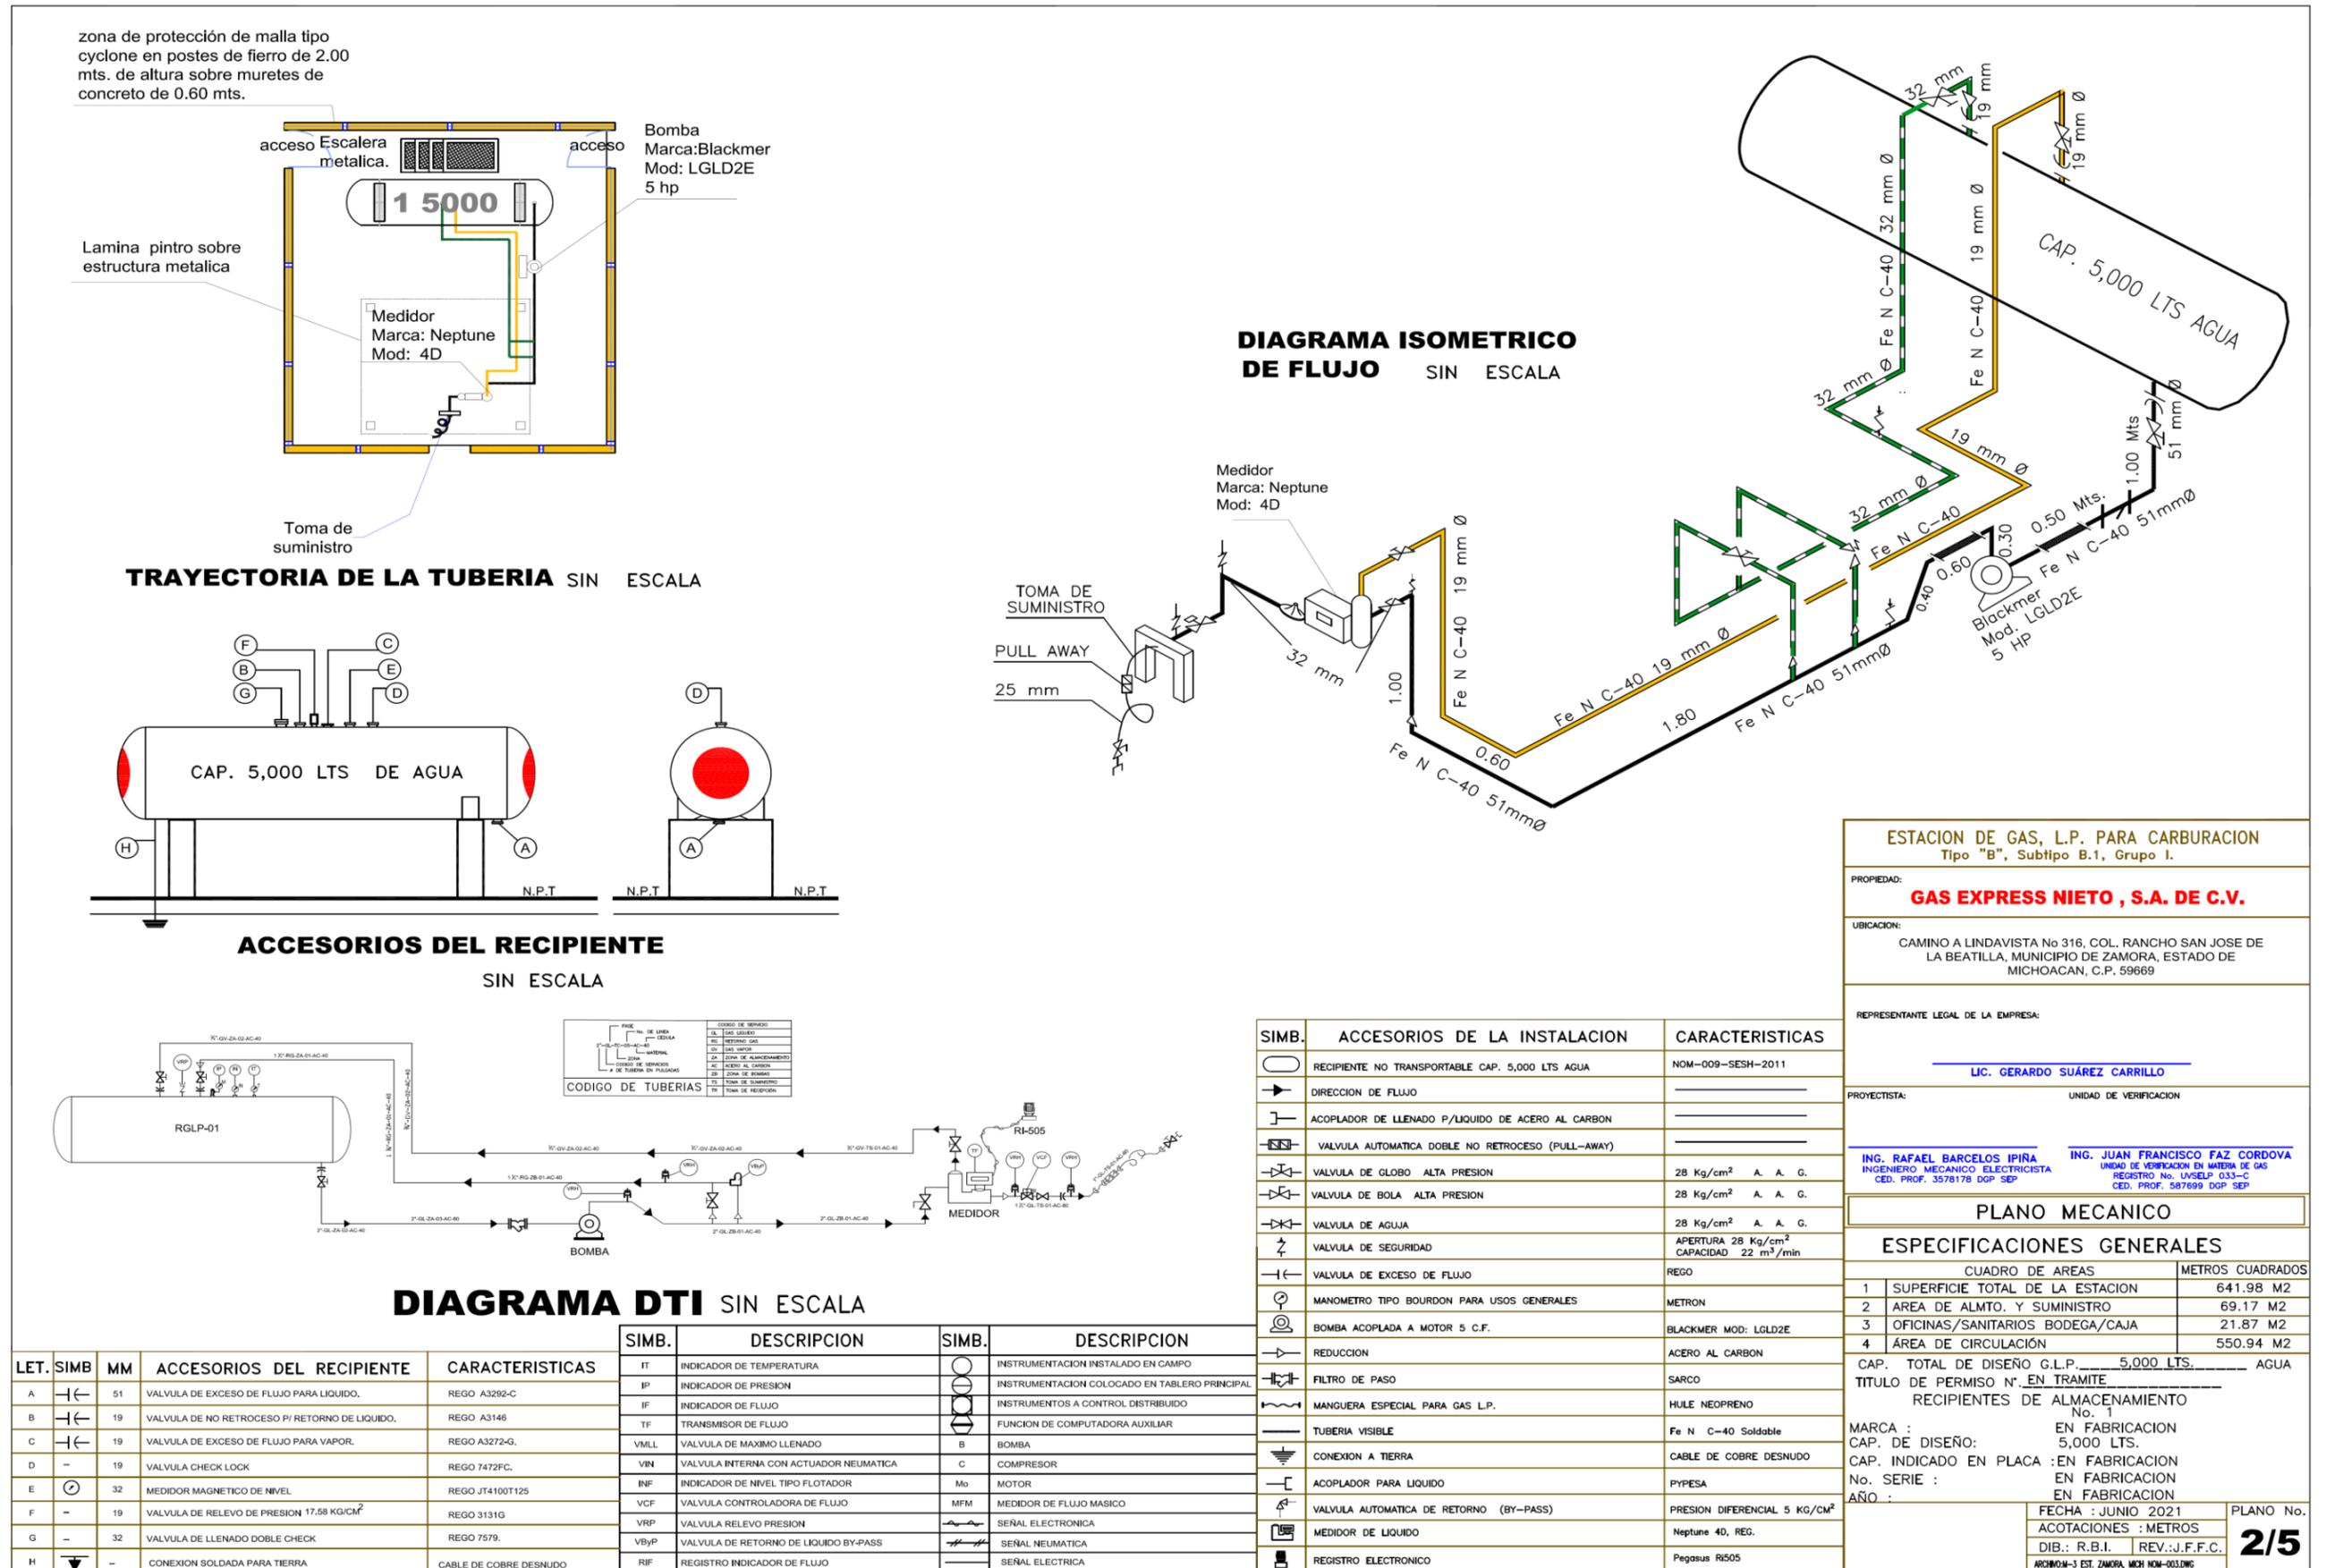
\_b. Plano mecánico sin escala con detalles del tanque de almacenamiento y equipamiento de la estación proyectada.
